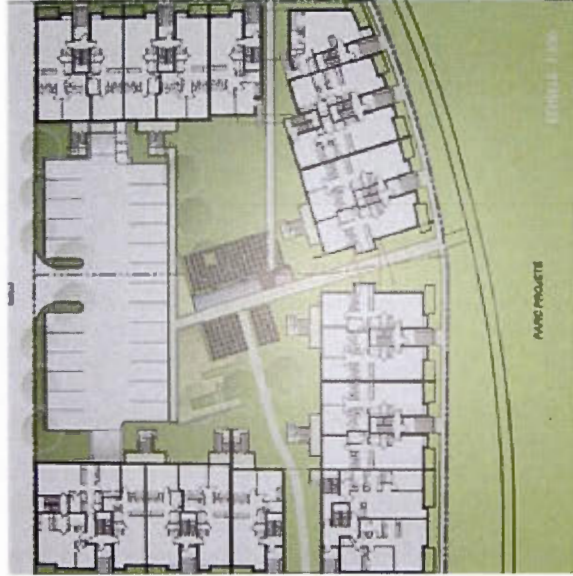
(suite) : Propositions reçues pour le volet privé de la transformation des terrains de Lavo
